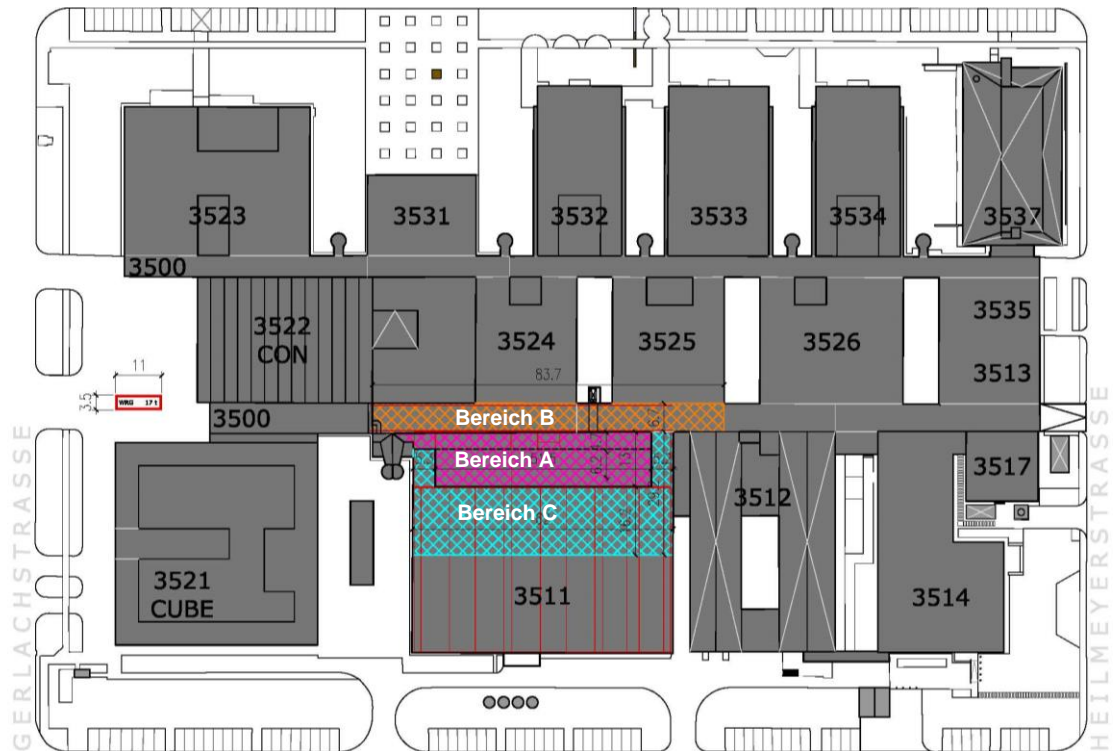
Gebäudekomplex 35 mit den zu untersuchenden Aufstellbereichen
